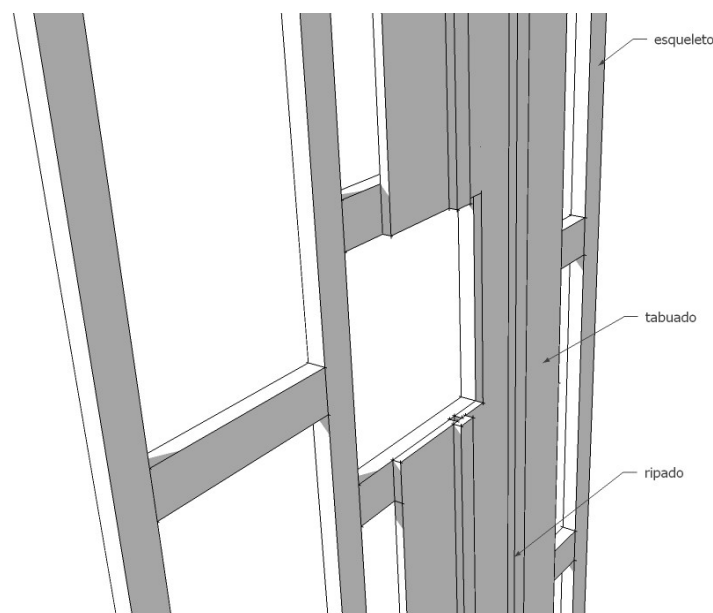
Sistema construtivo encontrado – desenho esquemático.
